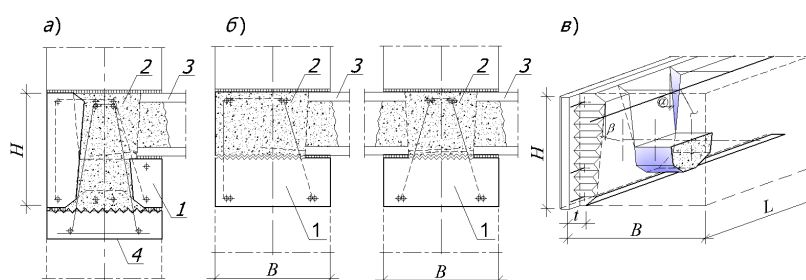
Сборно-монолитный пояс с перемычкой над обычными проемами (а, *Bm4*), над большими проемами (б, *Bm5*) и закрытый стык сборного поясного блока (в, фрагмент): 1-сборный блок, 2 - монолитный бетон; 3 - перекрытие; 4 - армо-бетоно-опалубочная перемычка [рис. автора].
